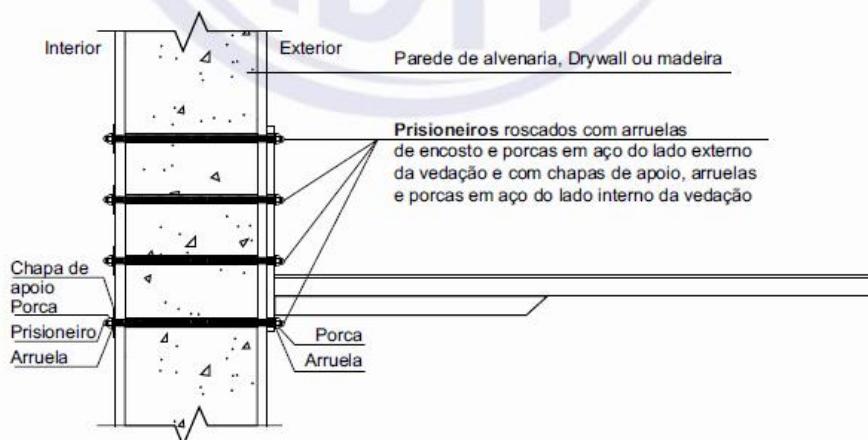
Exemplo de fixação de suporte em base de alvenaria, dry-wall e madeira
